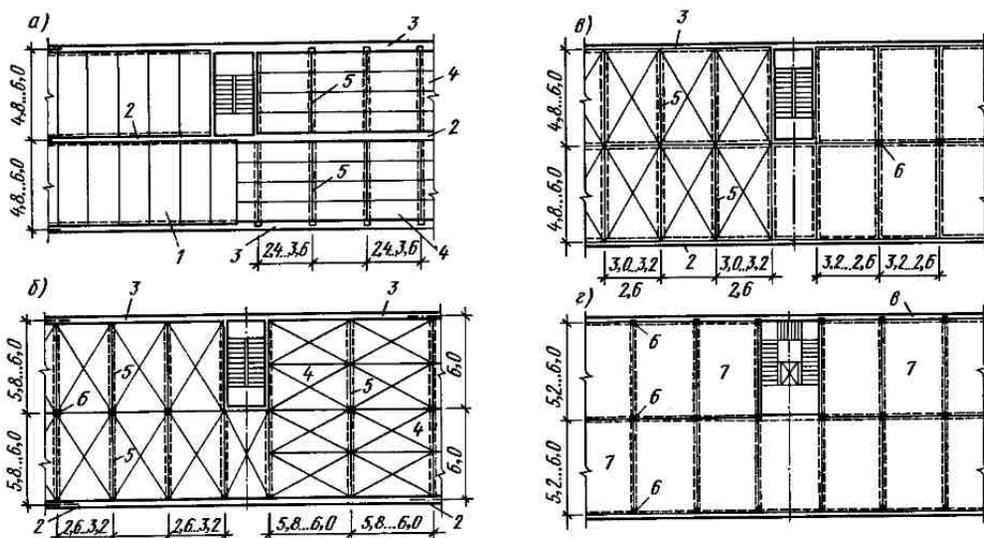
Конструктивные схемы плитных перекрытий:
